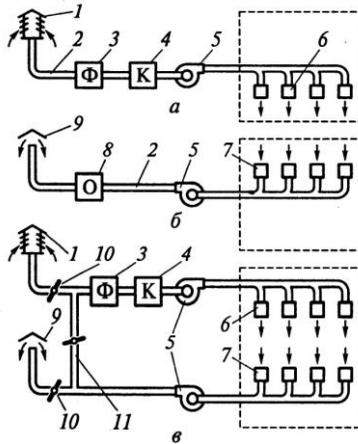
Схемы механической вентиляции: а – приточной; б – вытяжной; в – приточно-вытяжной с рециркуляцией: 1 – воздухоприемник; 2 – воздуховод; 3 – фильтр; 4 – калорифер; 5 – вентилятор; 6 – приточное отверстие (насадка); 7 – вытяжная решетка или насадка; 8 – устройство очистки воздуха от пыли; 9 – устройство для выброса воздуха (вытяжная шахта); 10 – заслонки для регулирования притока и вытяжки воздуха; 11 – рециркуляционный воздуховод.
